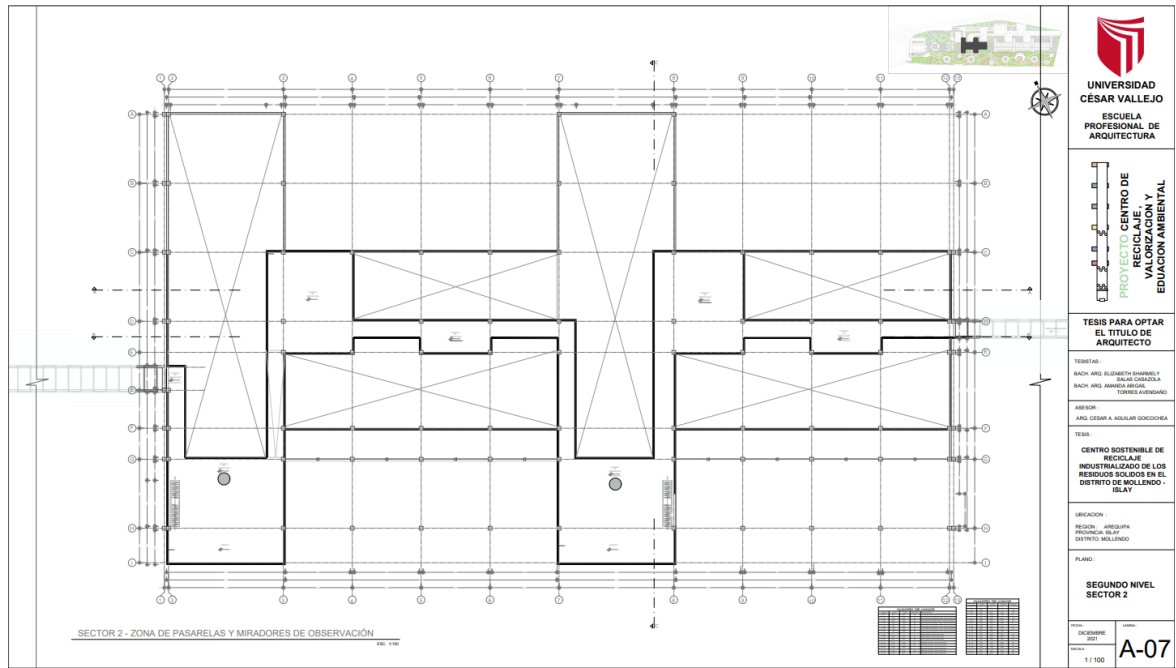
Planta de Distribución, Sector 2 – Segundo Nivel
